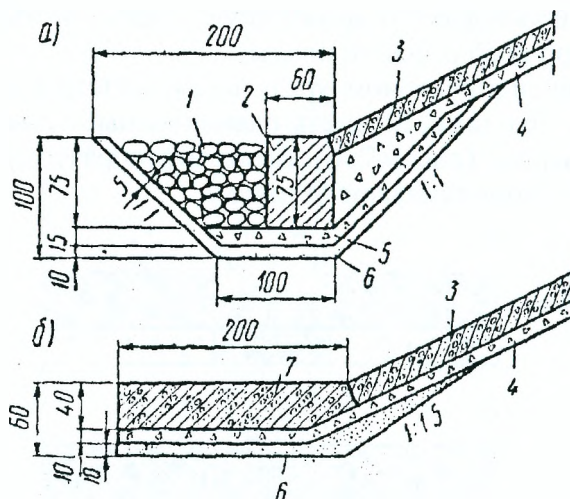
Сопряжение железобетонных плит укрепления откоса с неукрепленным дном: а – каменная упорная призма с бетонным упором; б – железобетонная упорная плита; 1 – каменная призма; 2 – бетонный упор; 3 – железобетонные плиты; 4 – щебеночная или гравийная подготовка; 5 – щебень или гравий; 6 – крупный песок; 7 – железобетонная упорная плита
